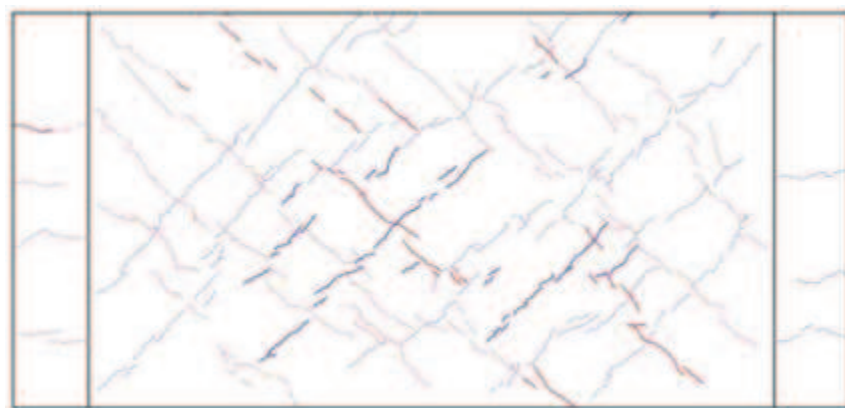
(6) 1/1000rad. におけるひび割れ図
